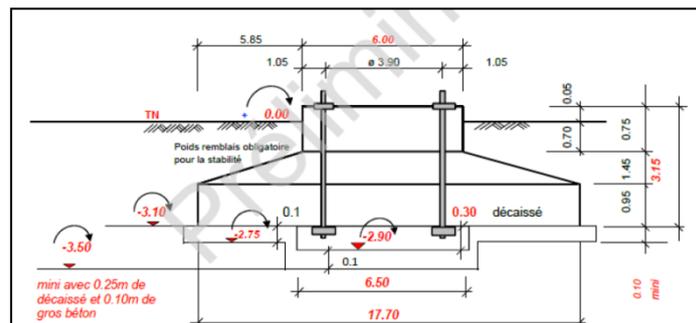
Fondations des éoliennes prévues sur le site (source : VESTAS)
